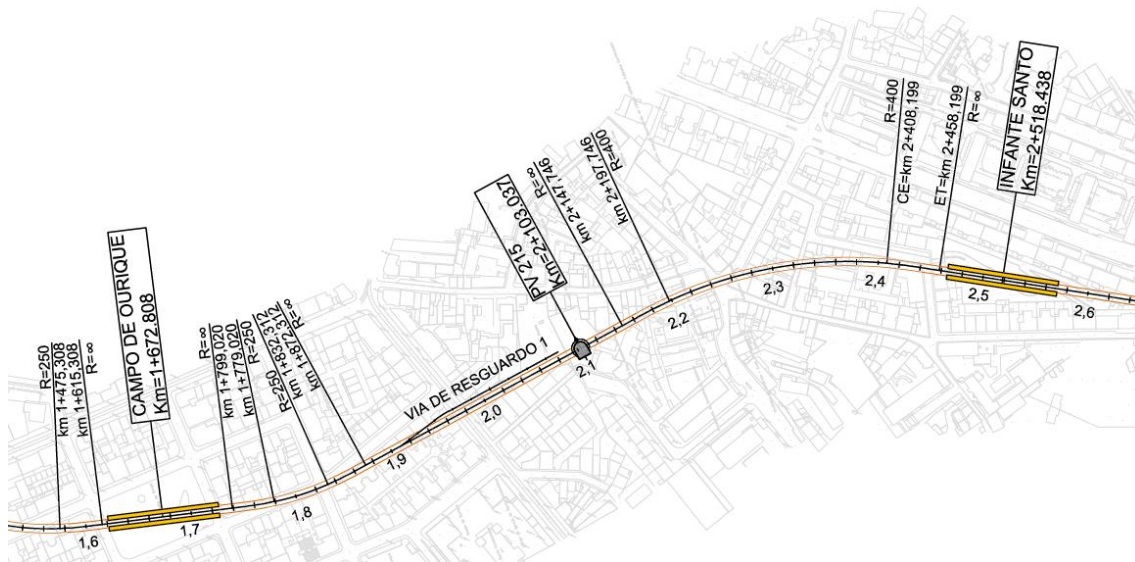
Traçado em Planta – 83º Troço – Infante Santo – Campo de Ourique
